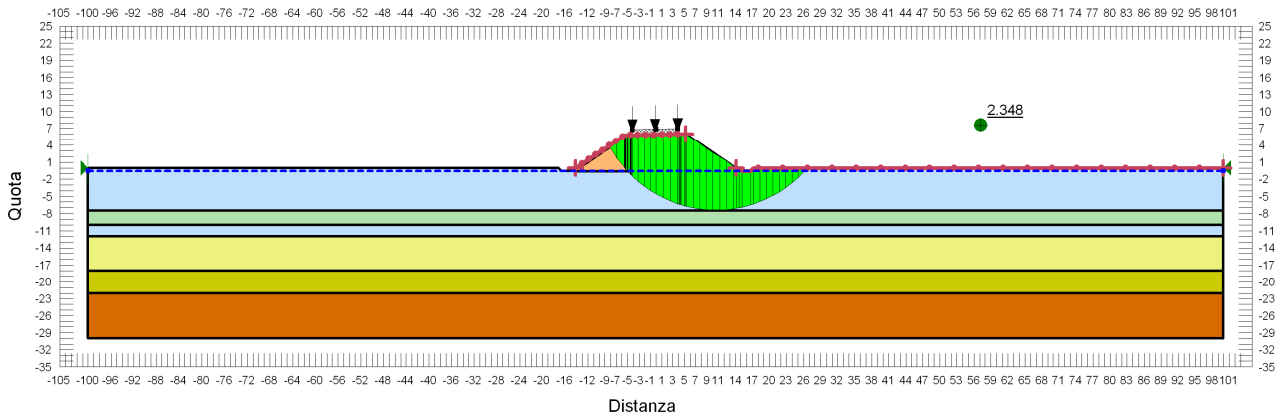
VERIFICA DI STABILITÀ GLOBALE RILEVATO DI H=6.00 M - CONDIZIONE STATICA NON DRENATA.
